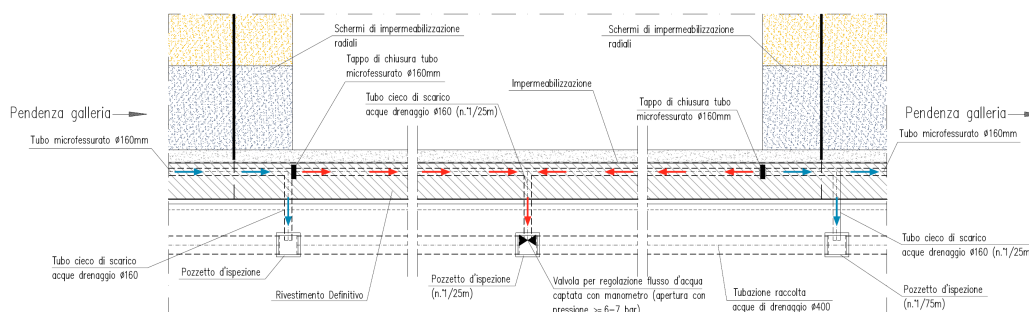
Impermeabilizzazione TIPO 2 -Schema planimetrico smaltimento acque bianche
